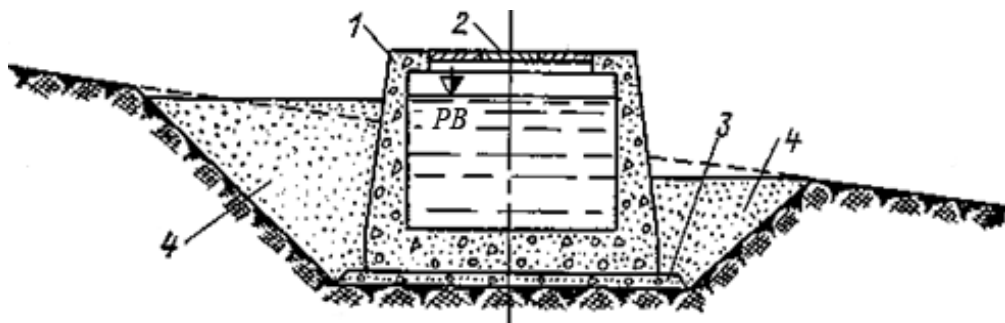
Поперечний переріз залізобетонного лотка:
